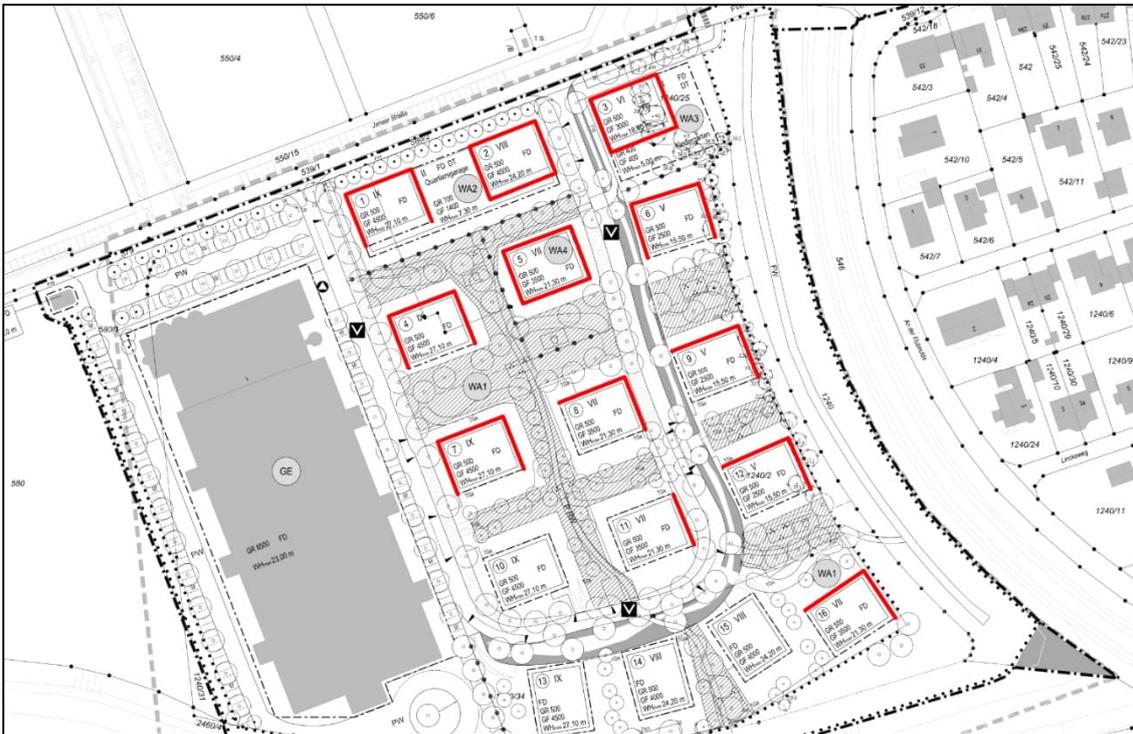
Lageplan mit Kennzeichnung der Fassadenbereiche (bis einschließlich 2. Obergeschoss), an denen Orientierungswertüberschreitungen zur Nachtzeit prognostiziert werden
